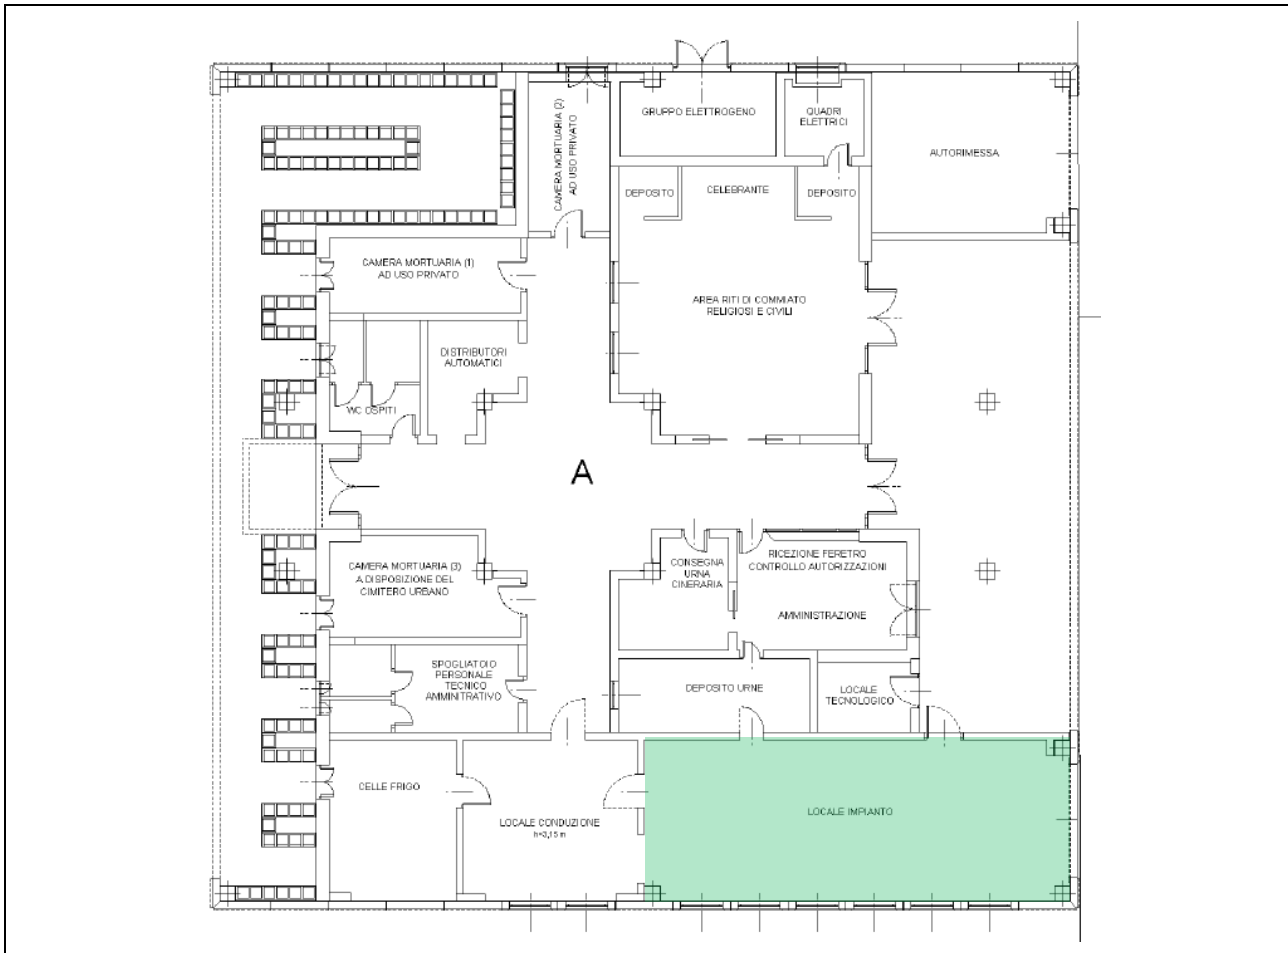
stralcio planimetrico impianto di cremazione – CATASTO FABBRICATI – Ufficio Provinciale di Biella
